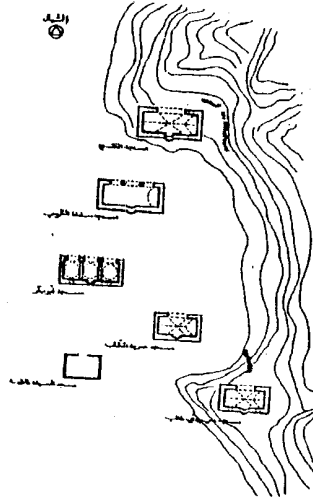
مسقط أفقى لمسجد زاوية
